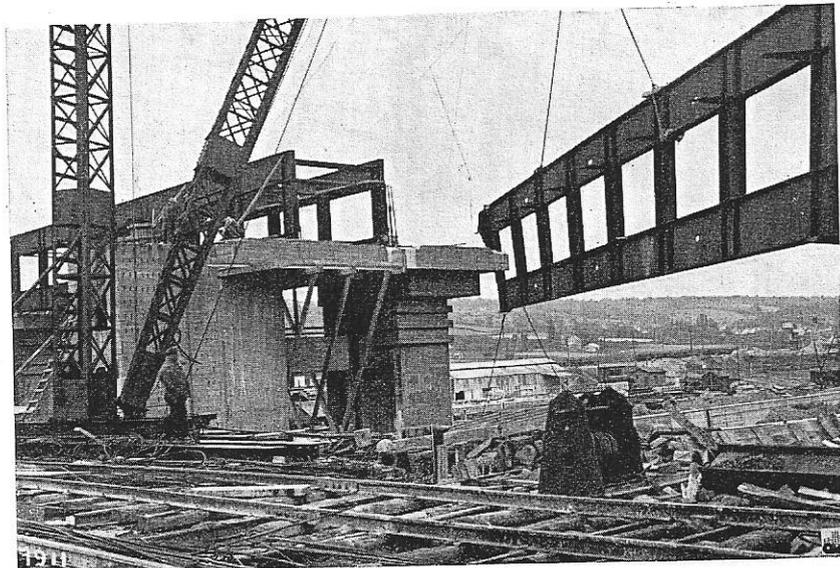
Montage d'une poutre Vierendeel de la passerelle.
